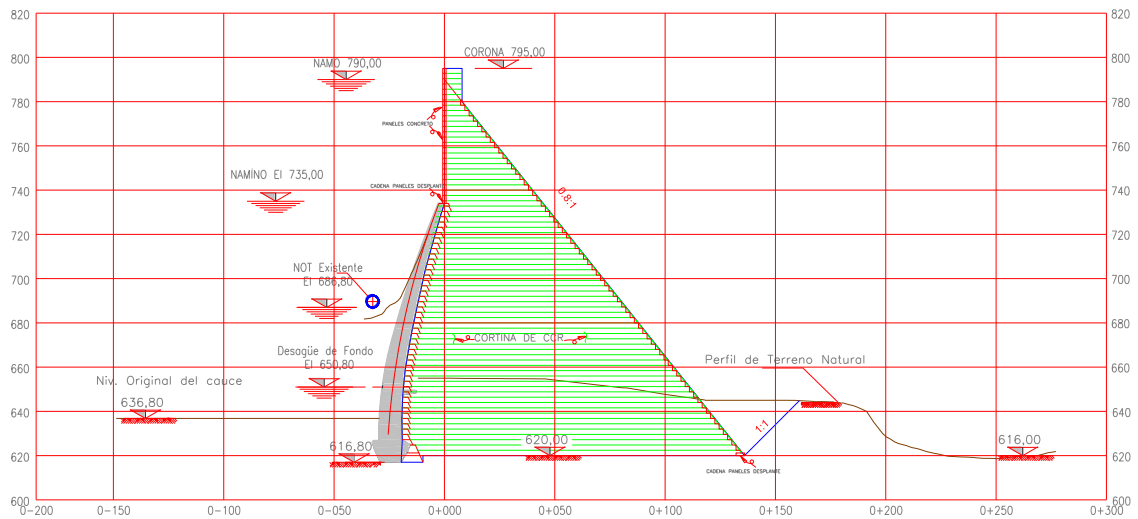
Perfil de la cortina de CCR propuesta para sobreelevar Santa Rosa.
